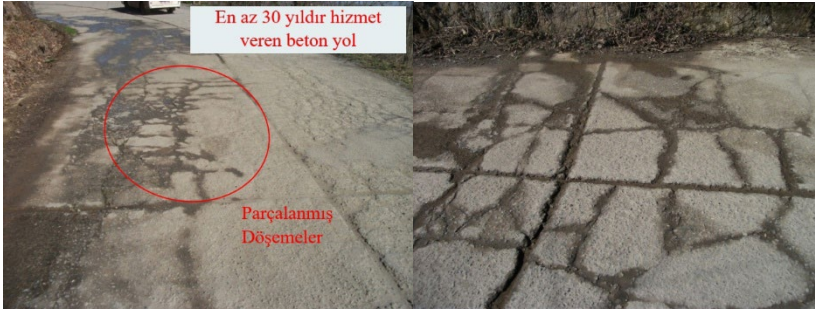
Trabzon Bulak Mahallesinde beton yollarda boyuna çatlaklar.
